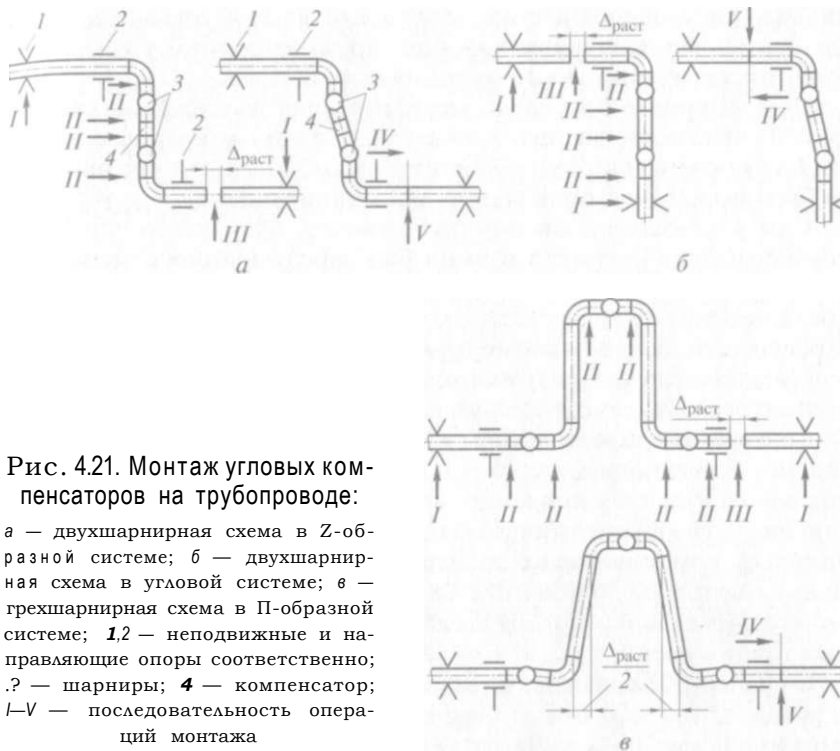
Монтаж угловых компенсаторов на трубопроводе:
